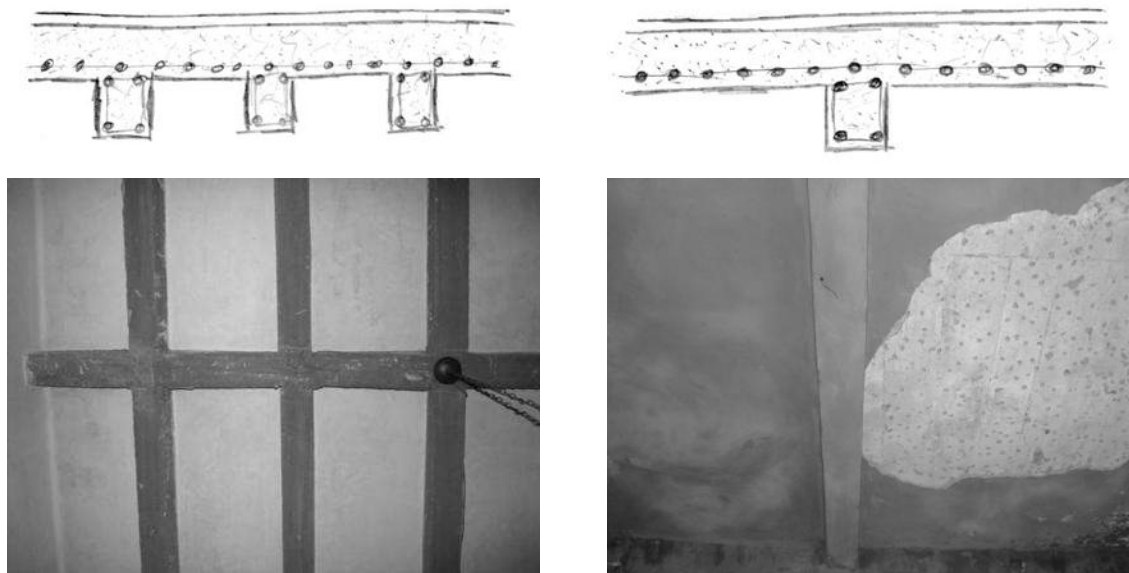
Fotografías y croquis de los sistemas de cubierta basados en losa y vigas de concreto armado, producto de intervenciones, en la mayoría de los casos se trató de imitar la vigería con el nuevo material (izquierda), mientras que en otro la viga aislada constituye un simple refuerzo (derecha). Dibujo y fotos: Eder García.
